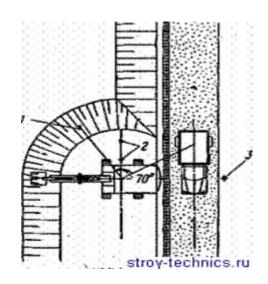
Схема разработки забоя прямой лопатой с погрузкой грунта в автосамосвалы:
